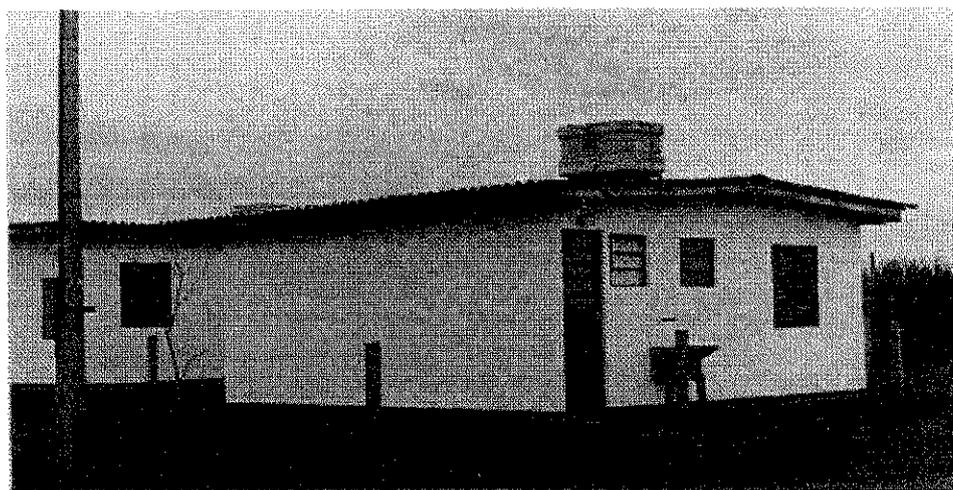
Processo construtivo "Lagotec ", casa pronta em concreto armado - Limeira (SP) - 1980.
